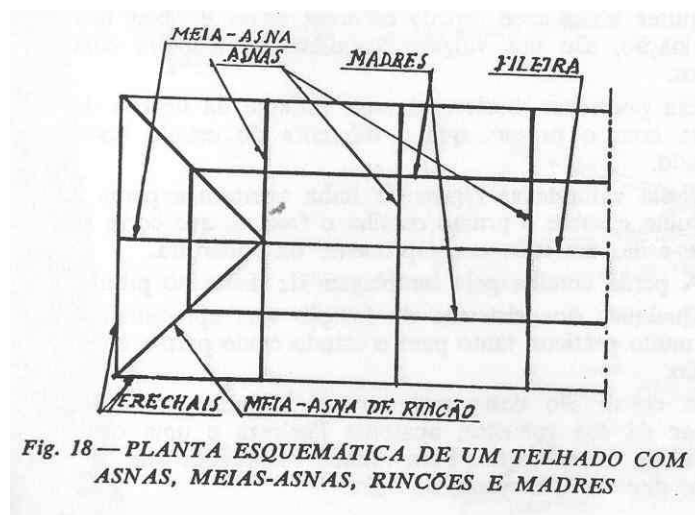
Planta esquemática da estrutura de uma cobertura tradicional (Costa, F.)
